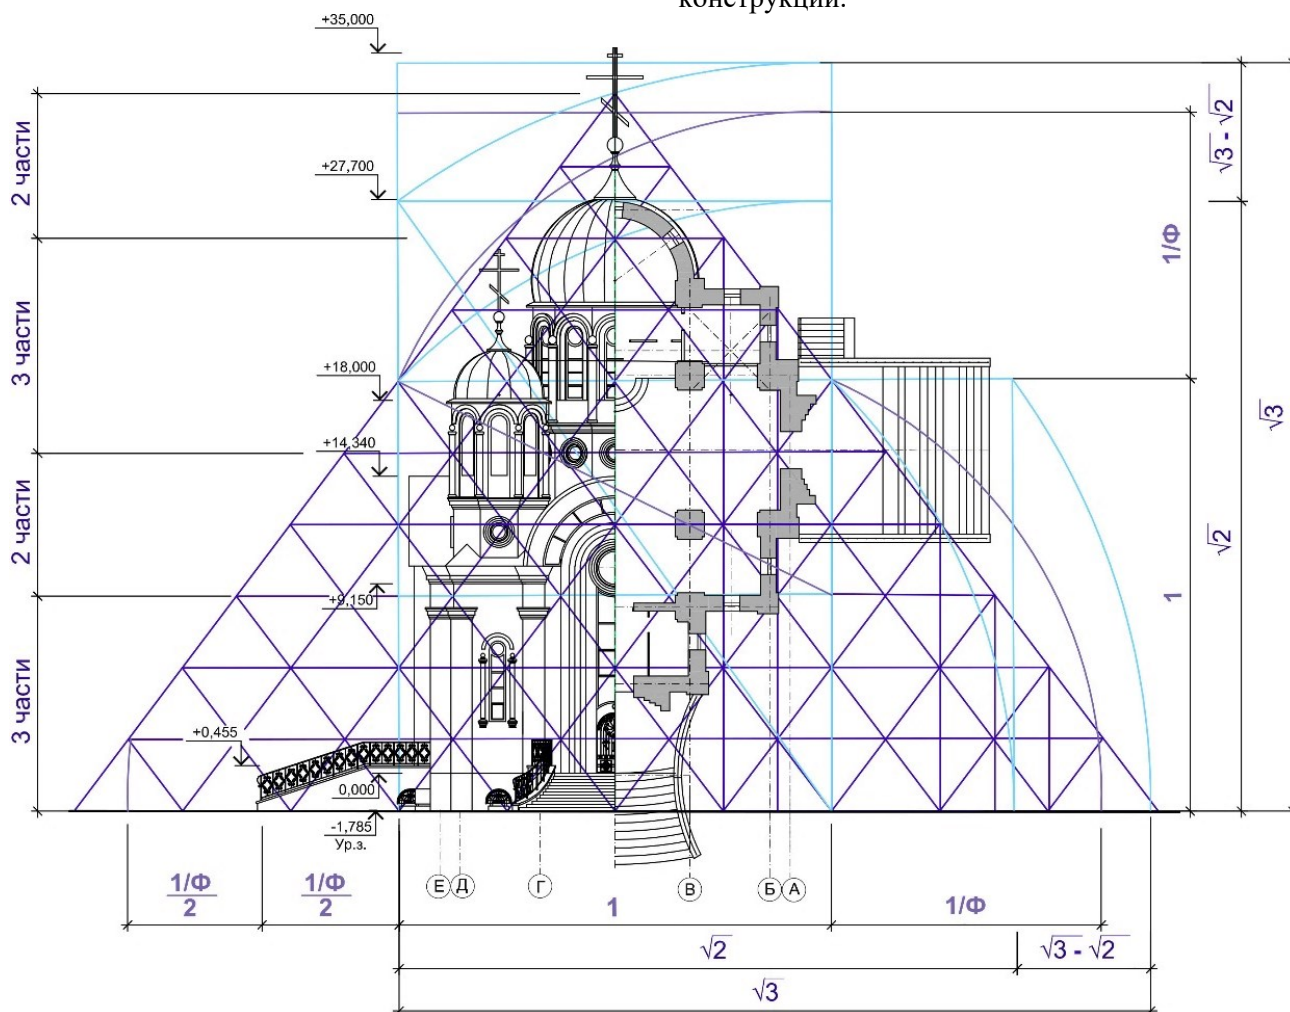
Совмещенная схема фрагмента фасада Е-А и плана первого этажа до реконструкции с выявлением пропорциональных зависимостей с помощью золотого сечения, метода триангуляции и динамических прямоугольников Джея Хэмбиджа с соотношением сторон $1 : \sqrt{2}$ и $1 : \sqrt{3}$
